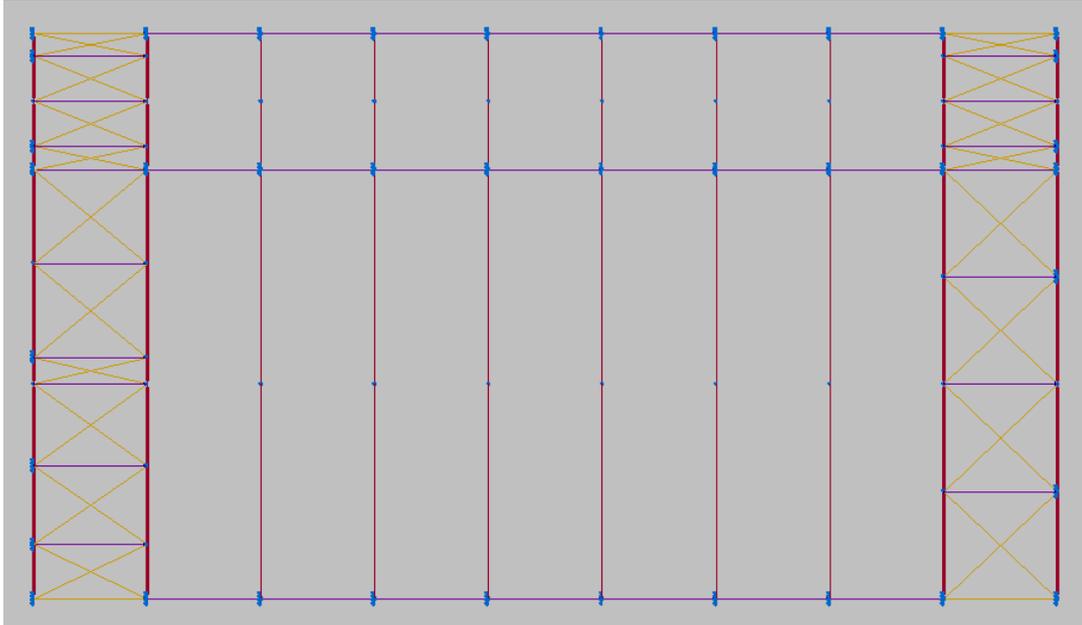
Vista en planta de las vigas contraviento simplificadas.
